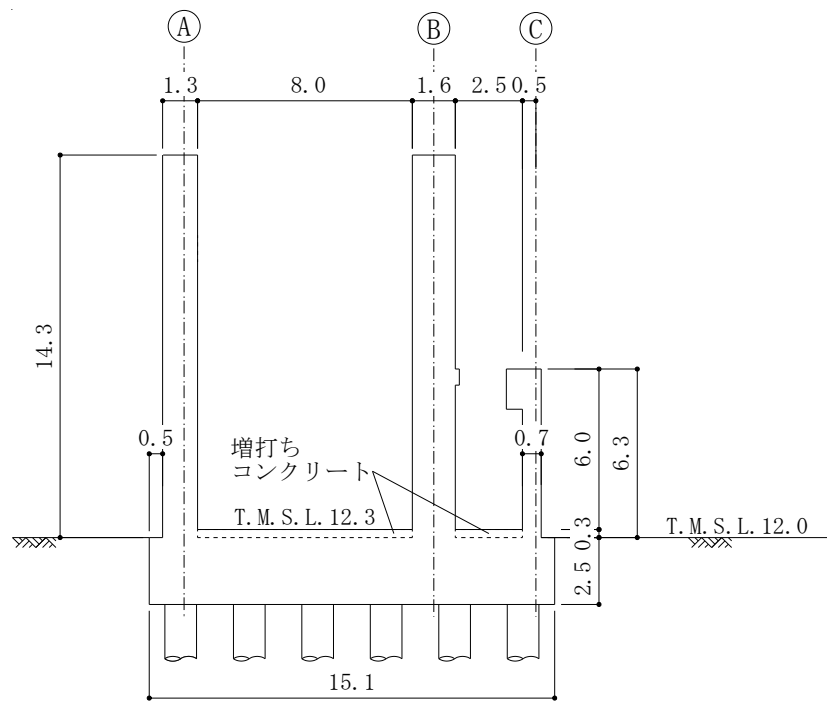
格納容器圧力逃がし装置基礎の概略断面図 (EW 方向) (単位 : m)
